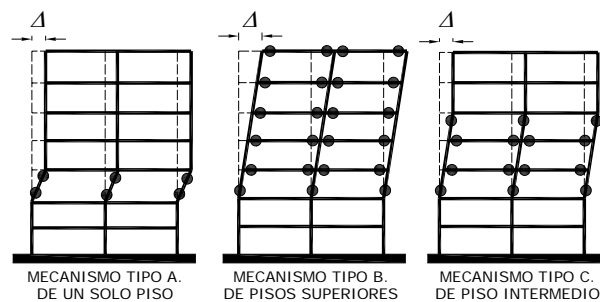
Tipologías de Mecanismos de Colapso.
